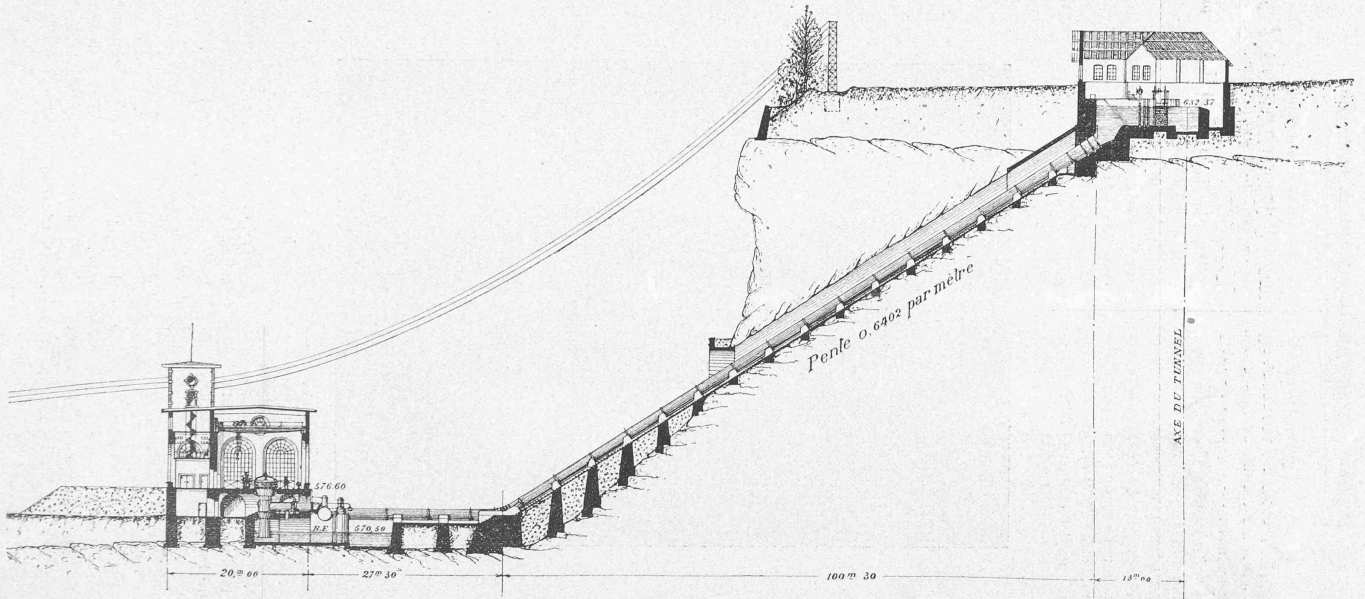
Coupe sur le bâtiment de mise en charge et l'usine, suivant l'axe du tunnel des conduites forcées.
